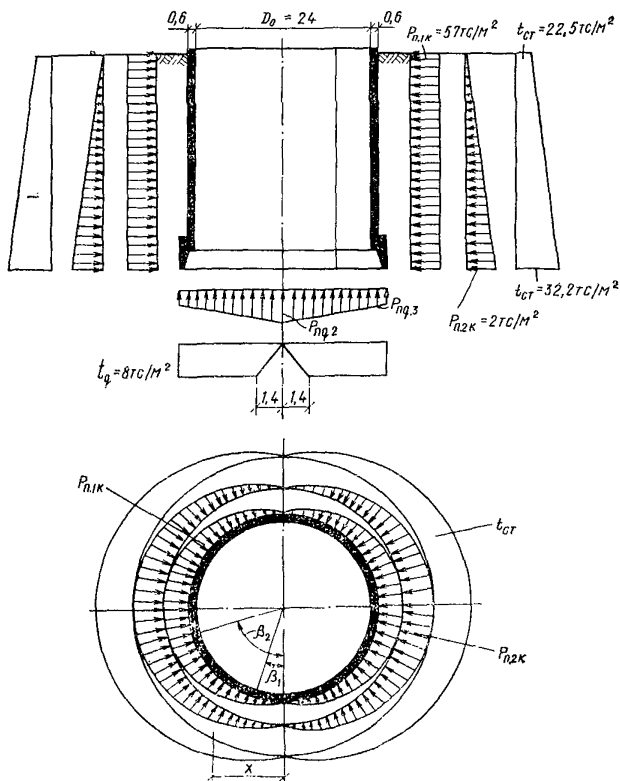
Расчетная схема круглого колодца в условиях подработки основания
